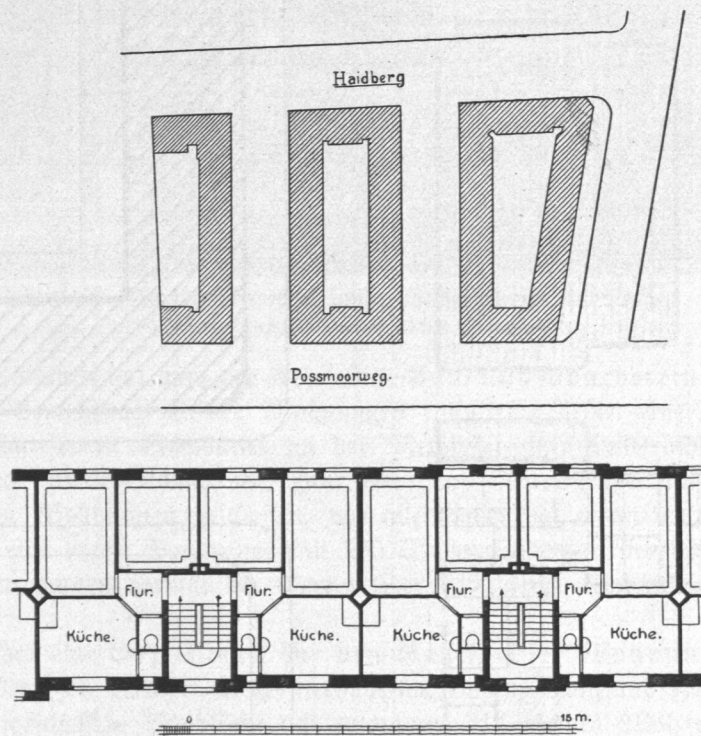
und 1203. Gesellschaft für den Bau kleiner Wohnungen, G. m. b. H., Winterhude, Lageplan und Obergeschoß.
